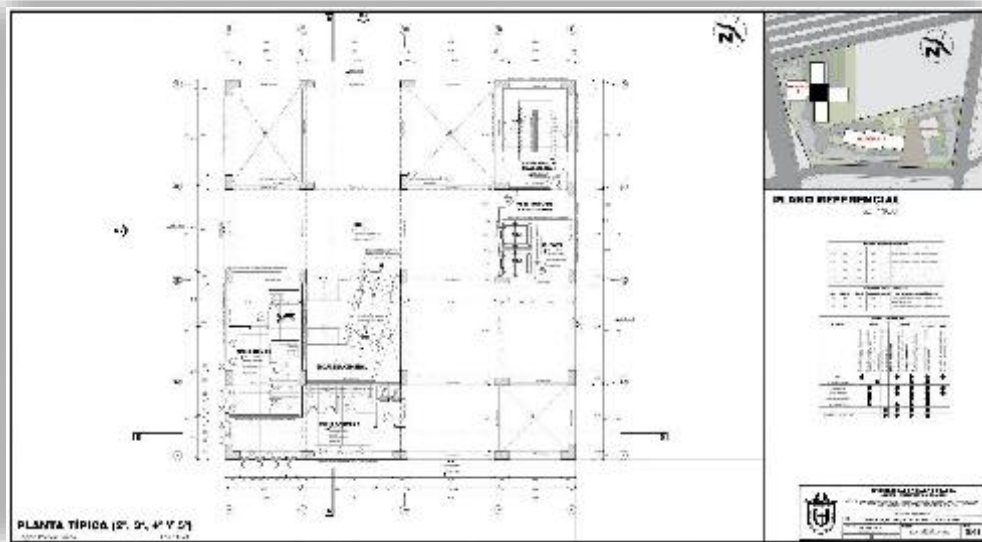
proyecto - planta típica 2°,3°,4° y 5° nivel sector hall
